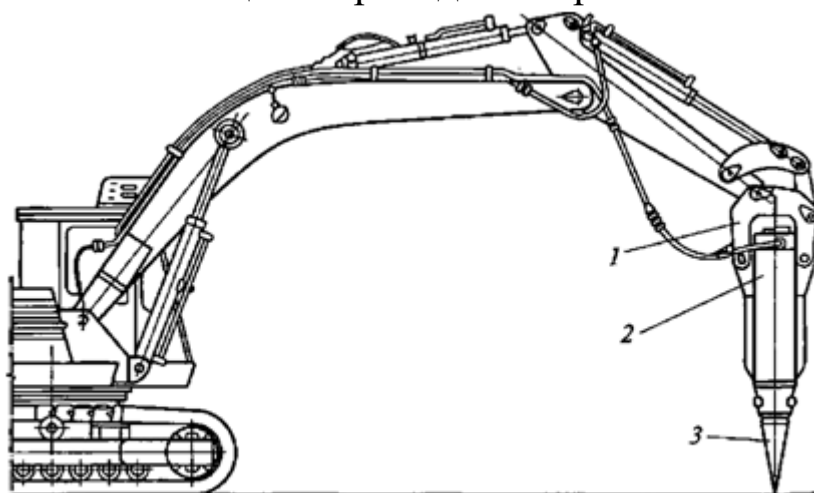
Одноковшовый гидравлический экскаватор с рабочим оборудованием гидромолота.
